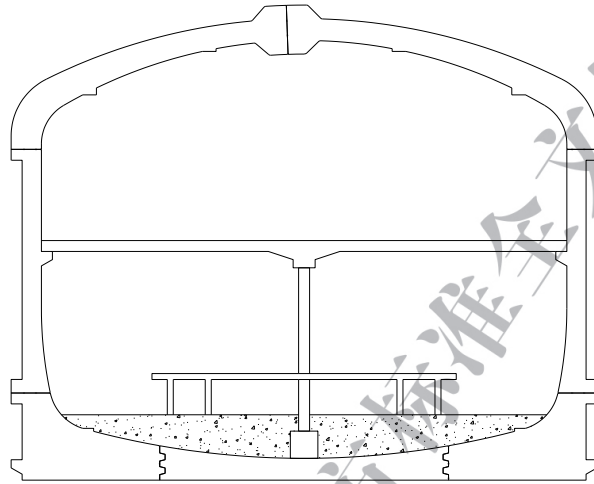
长春市地铁 2 号线装配式混凝土车站结构设计剖面图
